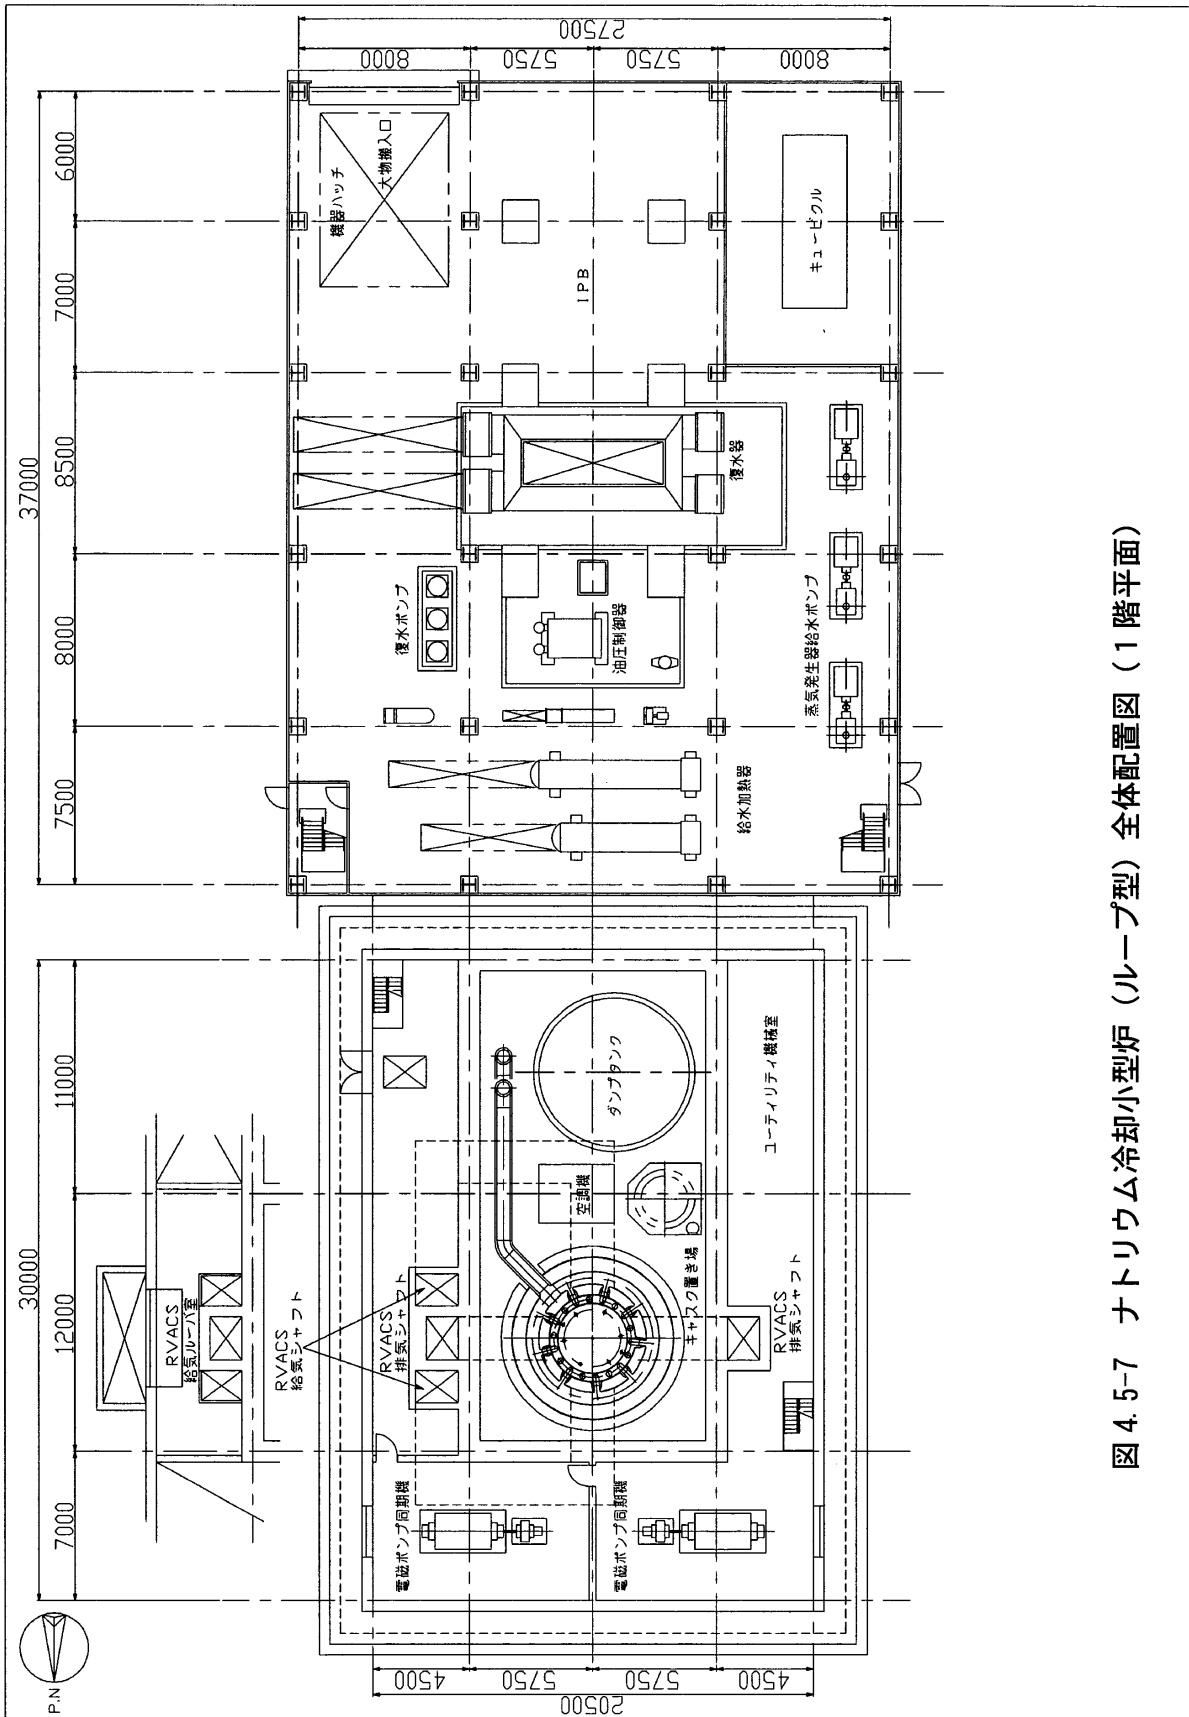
ナトリウム冷却小型炉（ループ型）全体配置図（1階平面）
